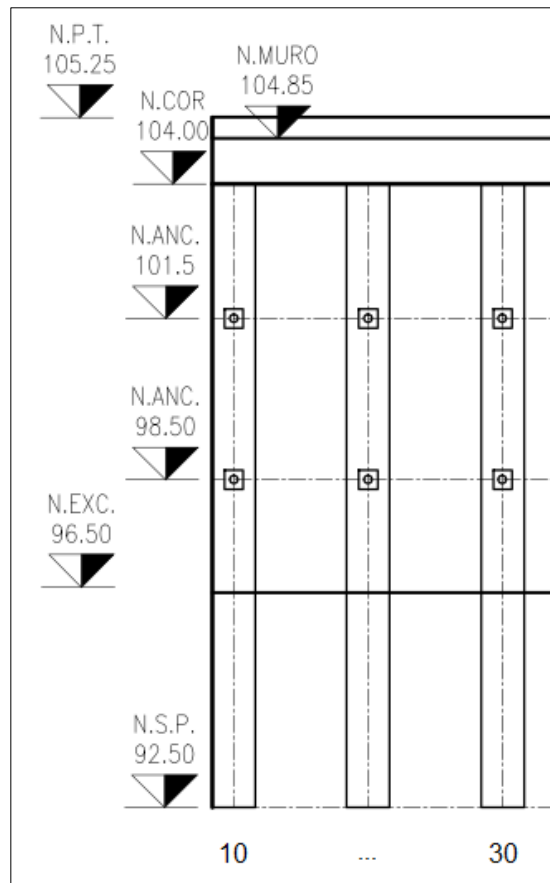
Vista en Elevación, pilas 10 y 30, plano Ferrara Ingeniería y Construcción.
